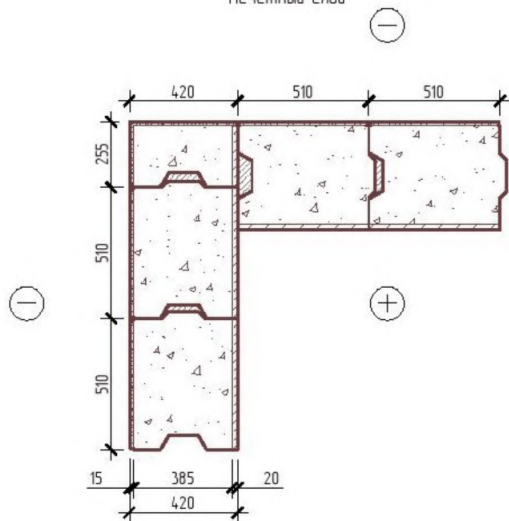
Принципиальная схема кладки наружных стен из керамзитобетонных блоков
